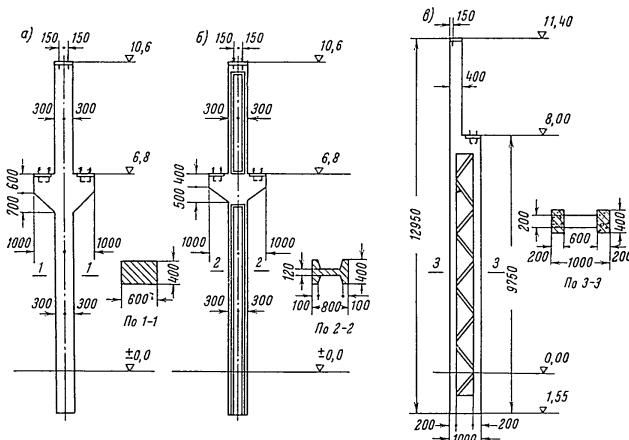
Сборные железобетонные колонны одноэтажных промышленных зданий
